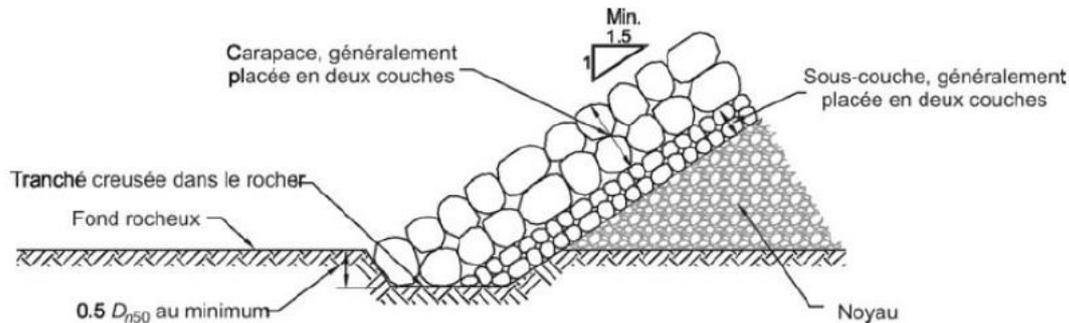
Détail d'un pied sur fond rocheux (source : Rock Manuel §6.3.4.1)
